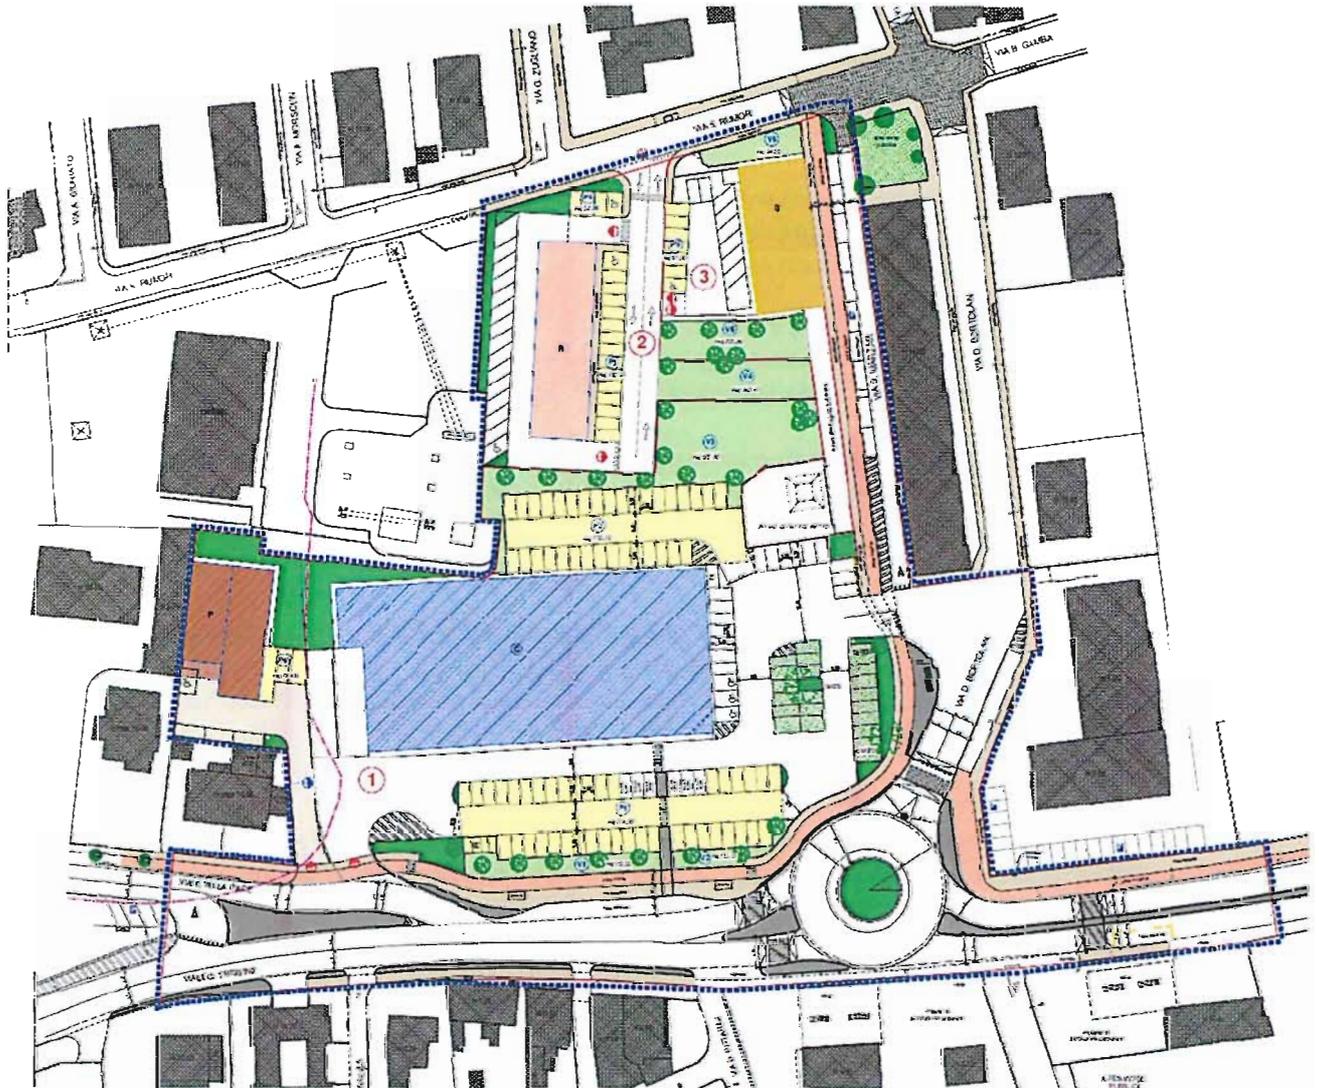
Planimetria del lotto con indicazione degli interventi da realizzare nell'ambito del piano urbanistico attuativo.
